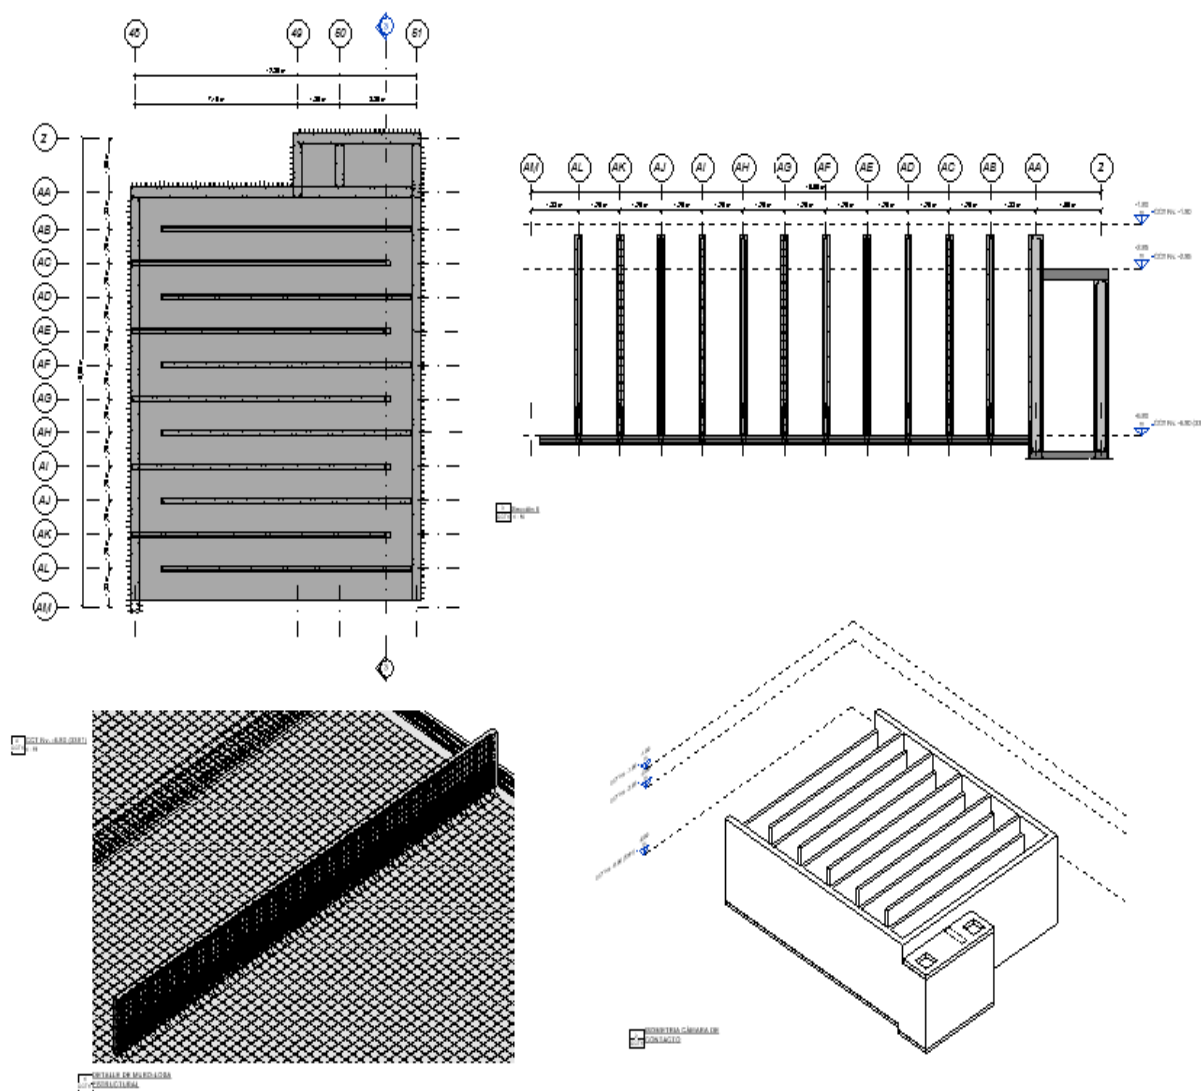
Isometría, planimetría de modelación estructural área de Cámara de Contacto CCT y muros verticales
